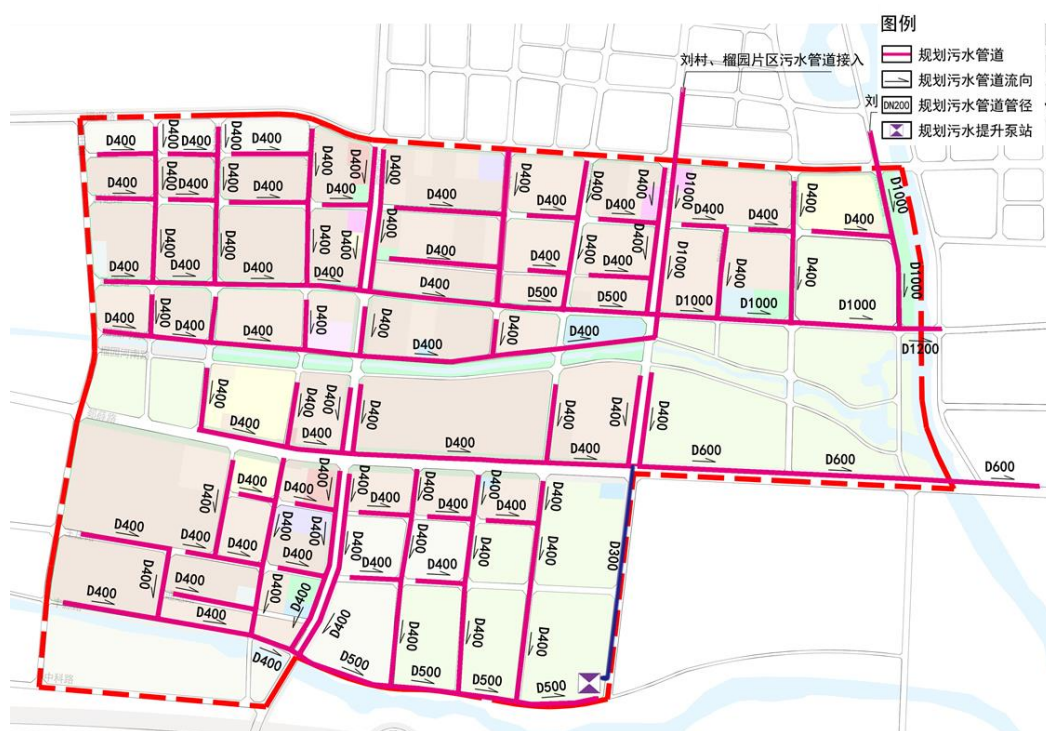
枣庄市峰城区文体中心片区规划污水管网平面布置图
